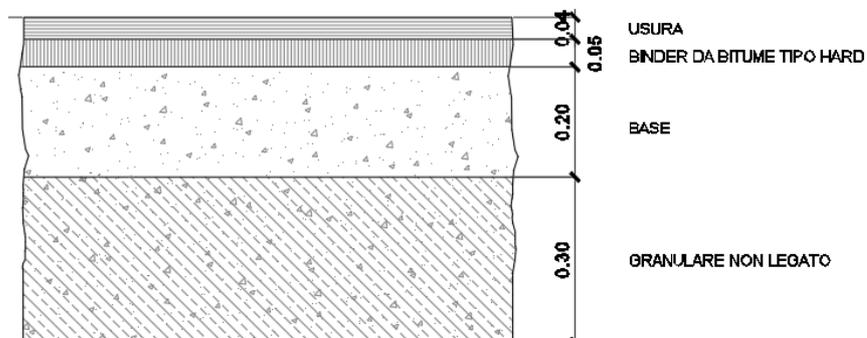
Sezione tipo della pavimentazione per l'intervento di riqualifica
